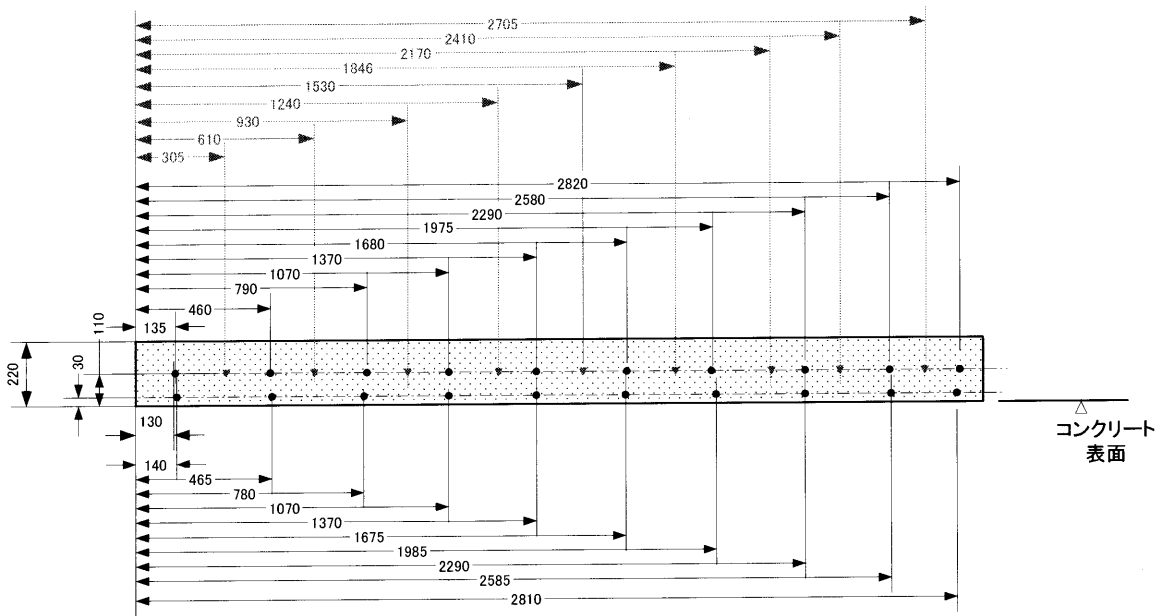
供試体② 側面 A 側 鉄筋位置
